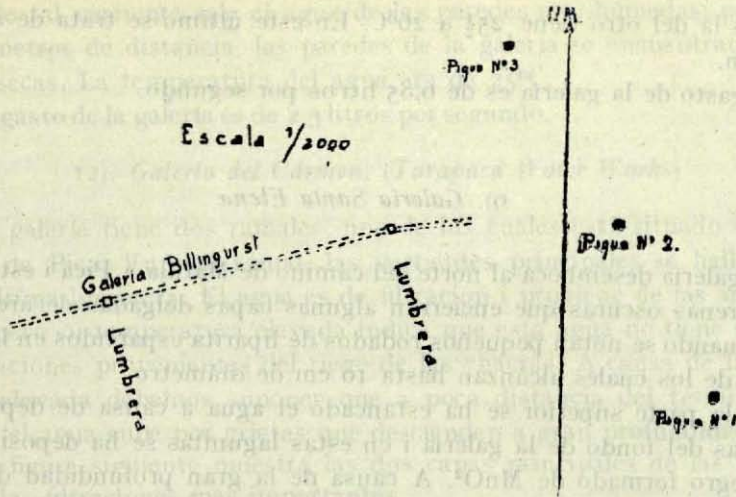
Plano de los piques i galería Billinghamst (Levantado por el señor Aguirre)
